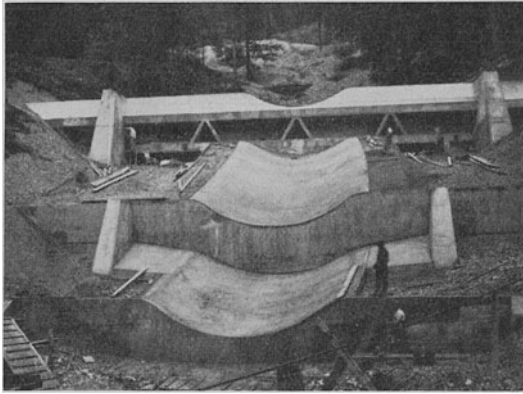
Eisenbetonsperre mit Kragträgerplatte, Winklergraben, Salzkammergut.
